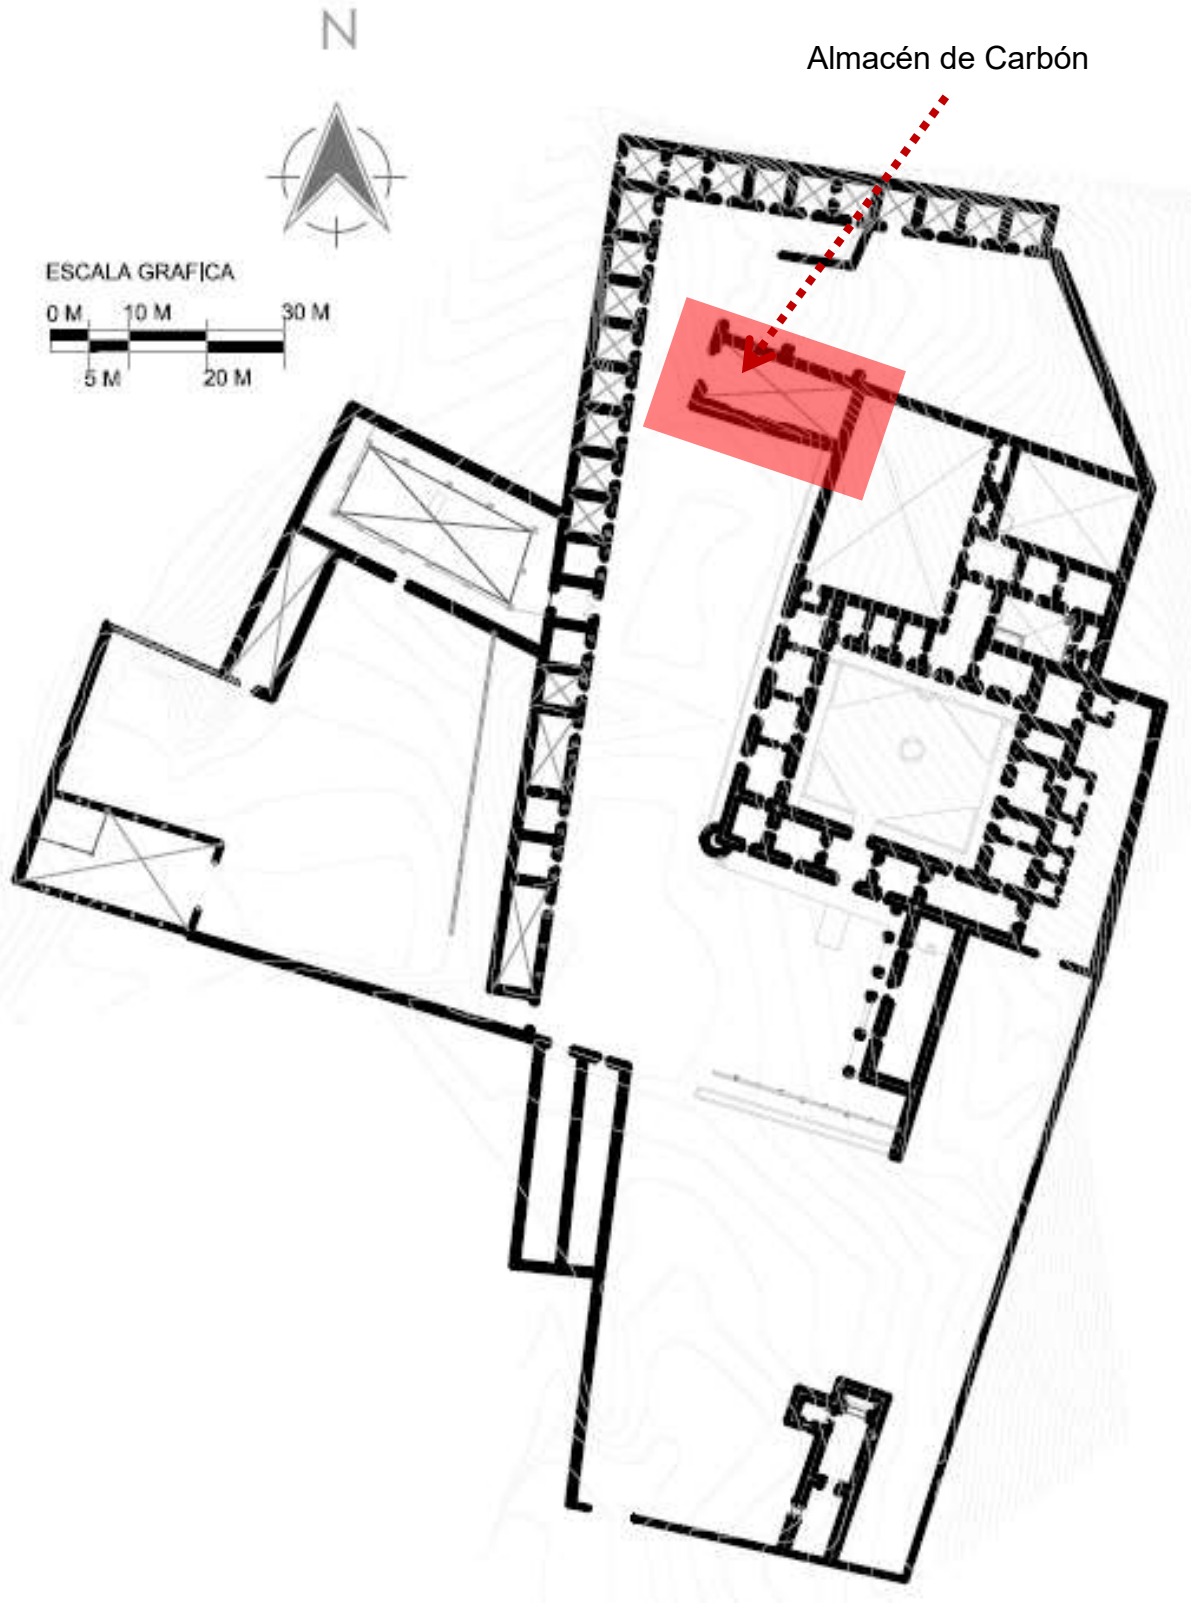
Planta de conjunto de la hacienda y ubicación del Almacén de Carbón.
